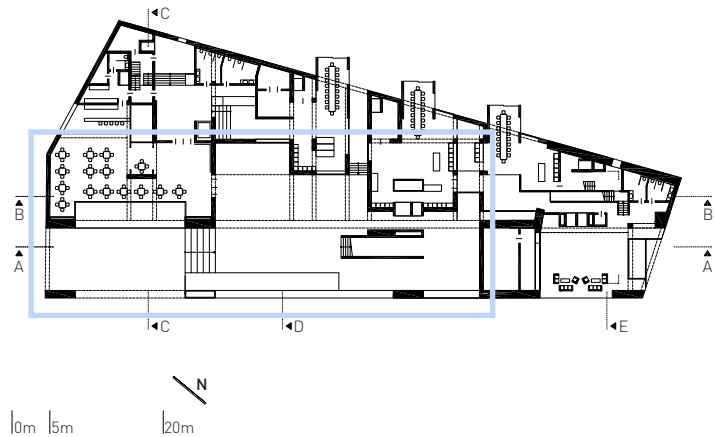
Grundriss EG +0,00m/+1,00m
